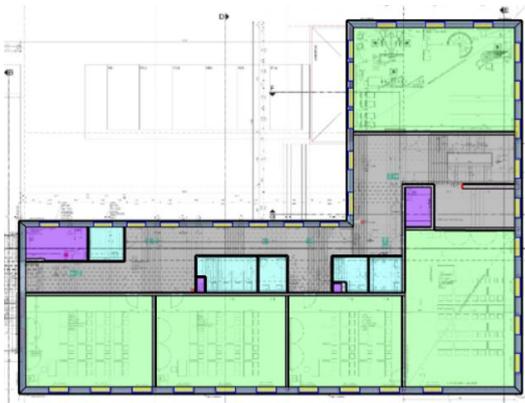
Grundriss Obergeschoss, zoniert
